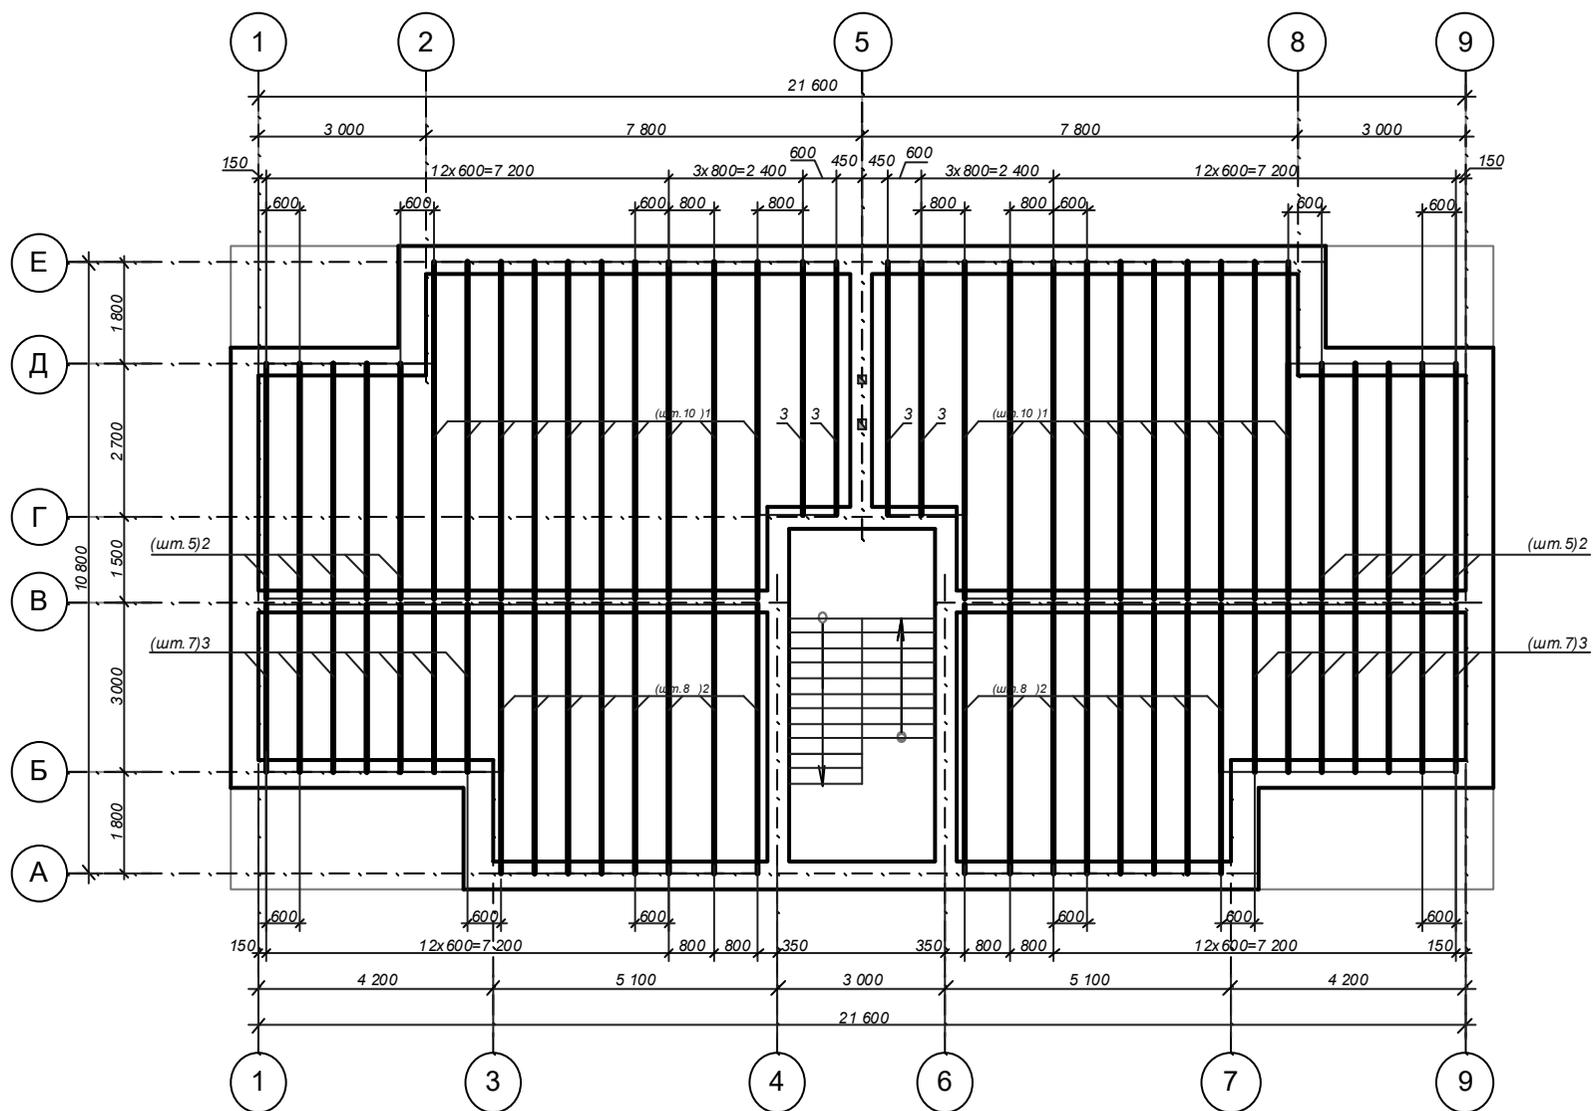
Пример оформления схемы расположения элементов балочного перекрытия
